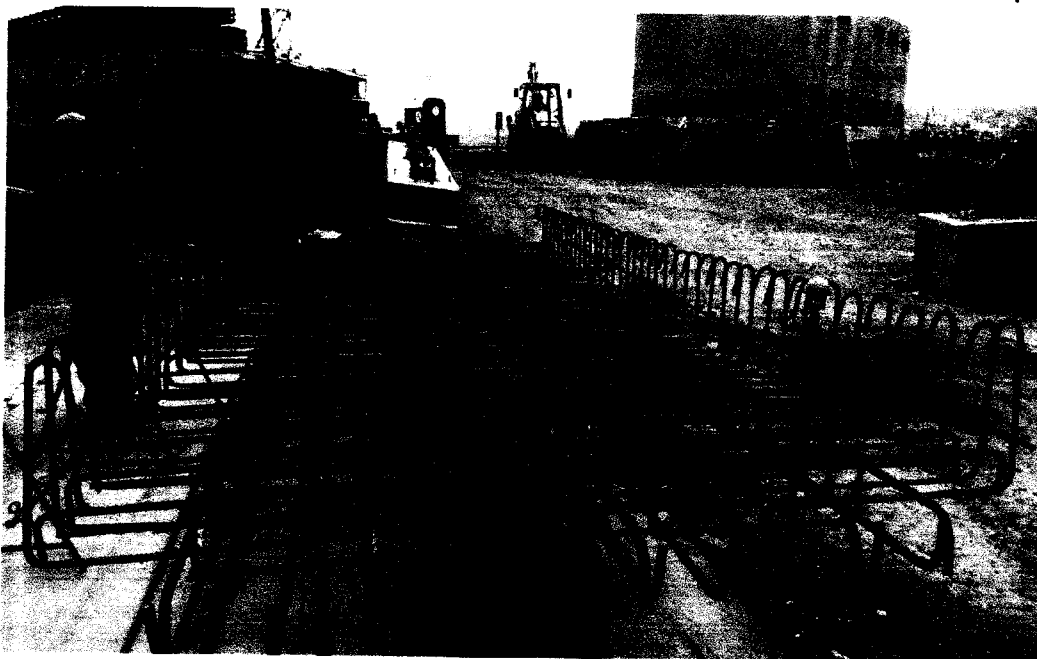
Acero Estructural de Losas Nervadas para cabezo en el muelle.
